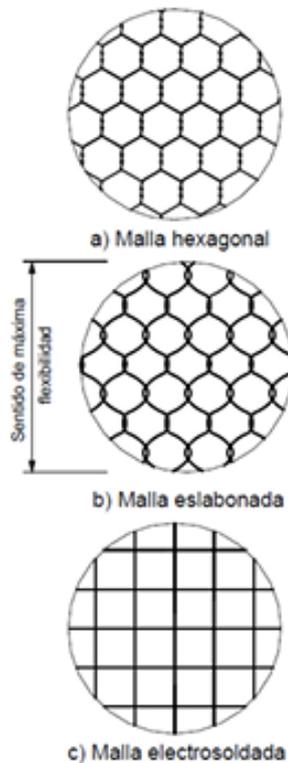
“Los tipos de mallas utilizados en la construcción de gaviones.”
